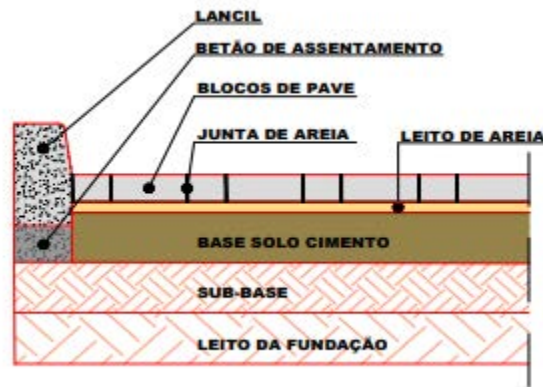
Base em solo cimento- Estrutura de pavimento de blocos com base de solo-cimento (Fonte: GPEUM)
